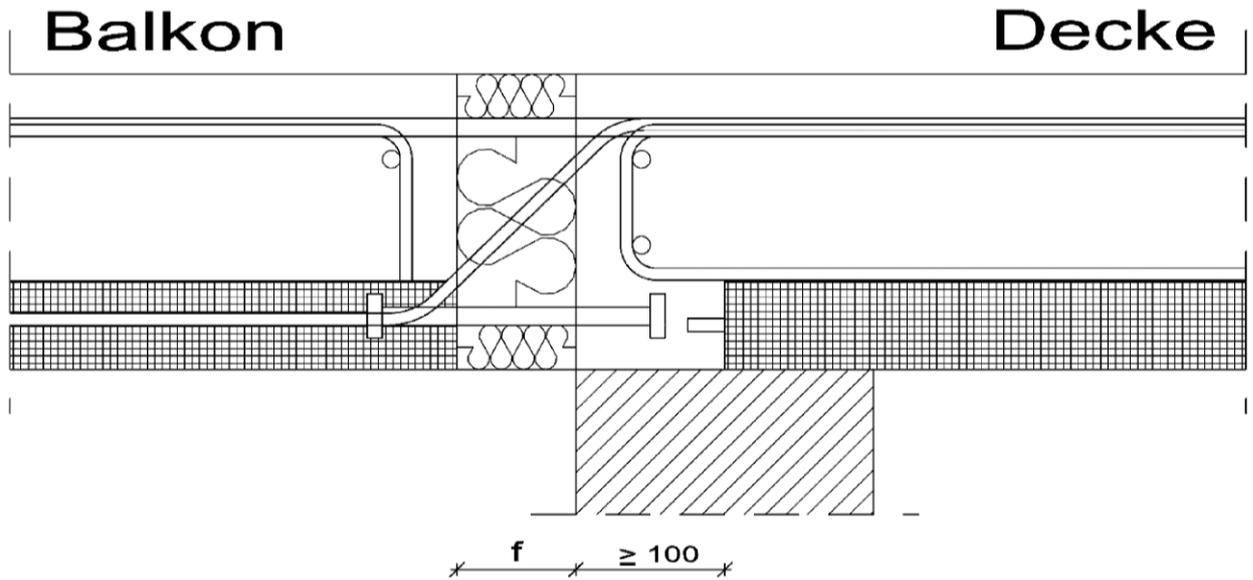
Beispiel in Elementdecken - Bügel auf dem Elementdeckenspiegel
